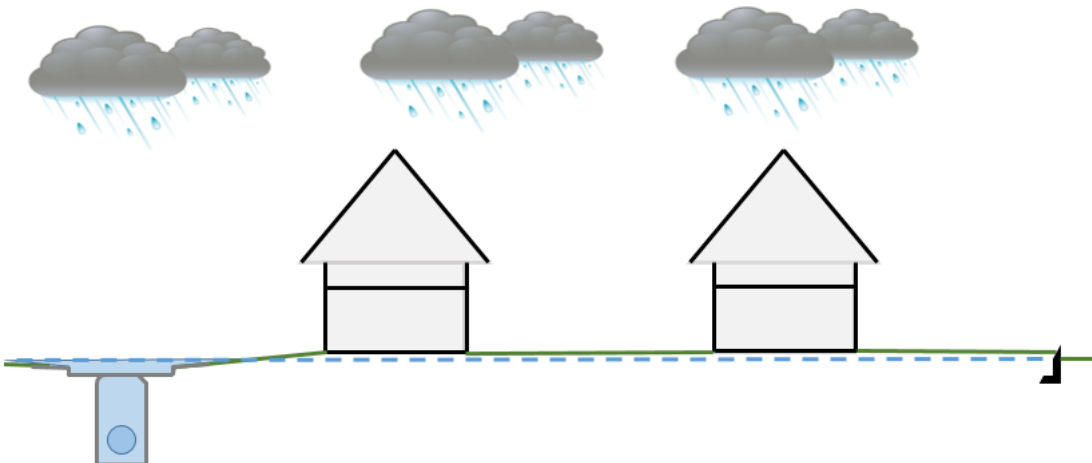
Hinterbebauung Westseite Wahrkamp (Blickrichtung Süden) mit Geländegestaltung (Abwasserwerk Coesfeld 2021)
